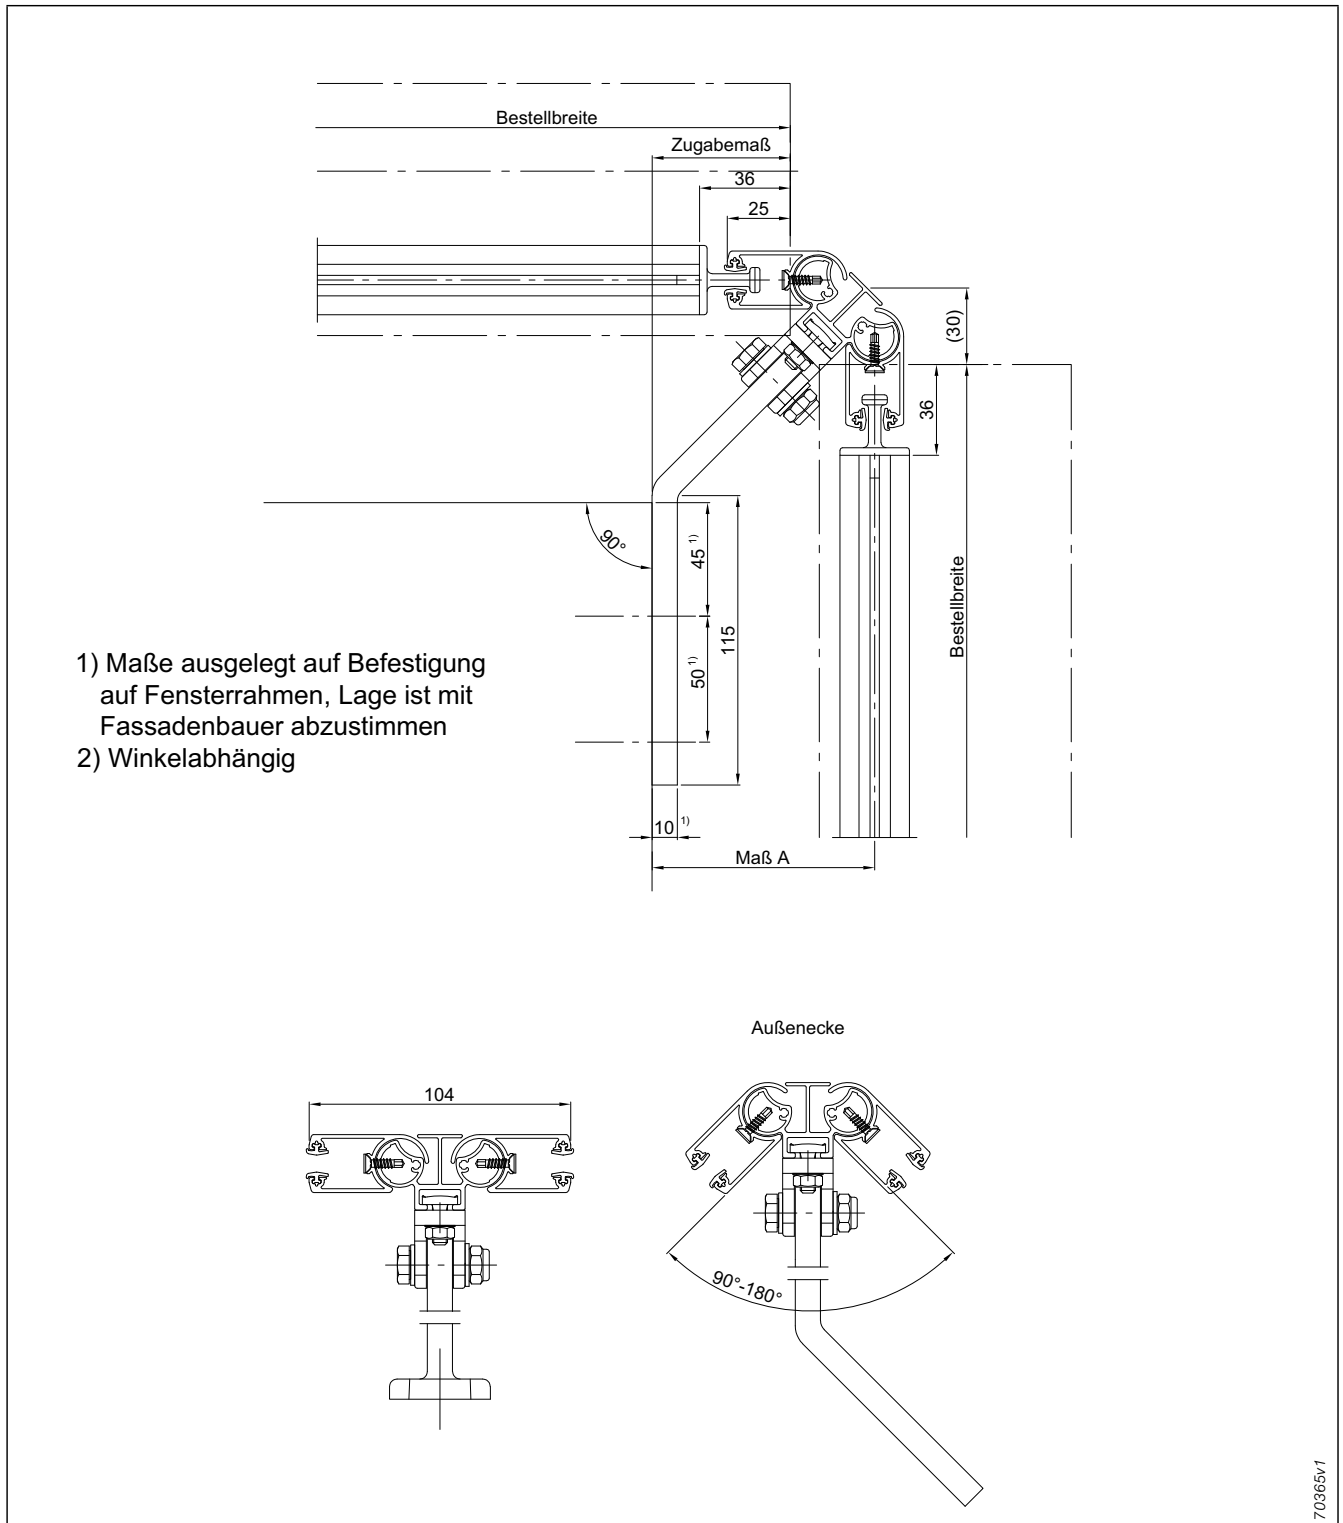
Winkelverstellbare Eckführungsschiene für Ecksituationen und polygonale Fassaden
